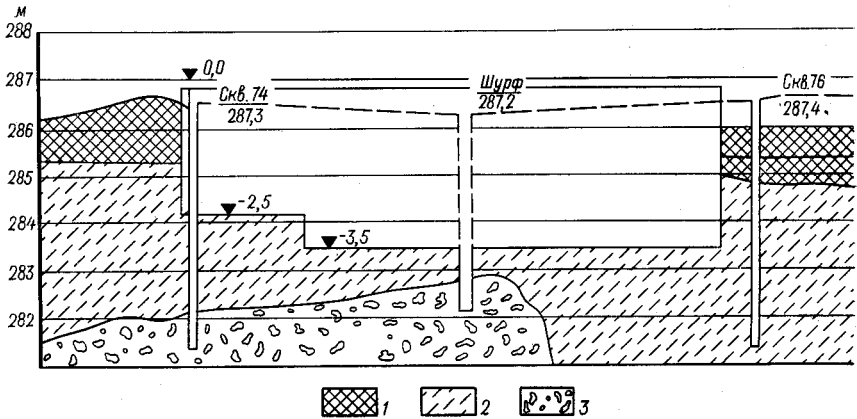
Продольный инженерно-геологический разрез грунтов основания
